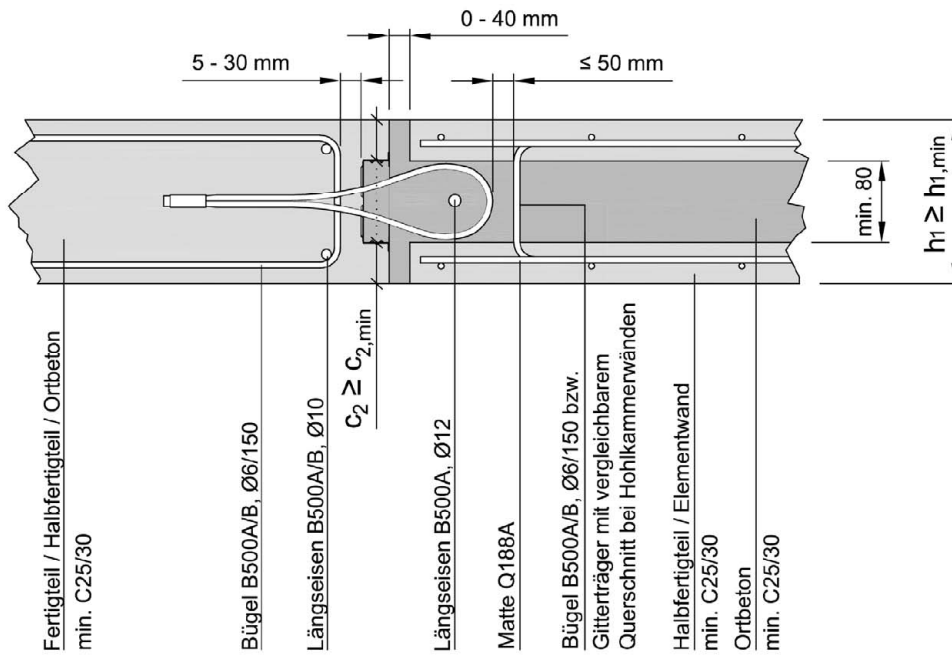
Regel-Querschnitt mit Halbfertigteil / Elementwand, Bewehrung
